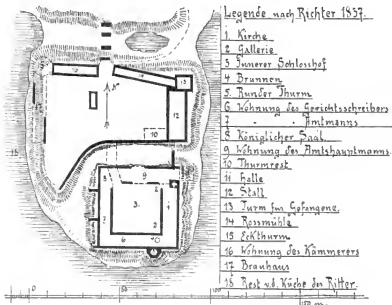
Grundriss der Burg Pr.-Mach.
